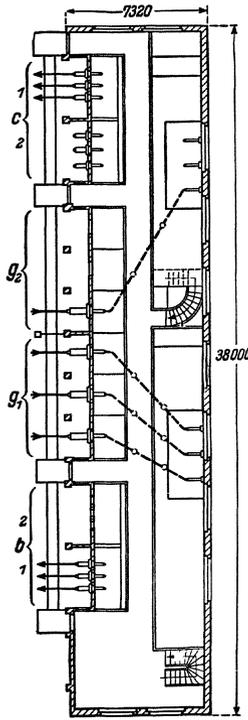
Obergeschoß mit ankommenden und abgehenden Leitungen. Grundriß III—III.
